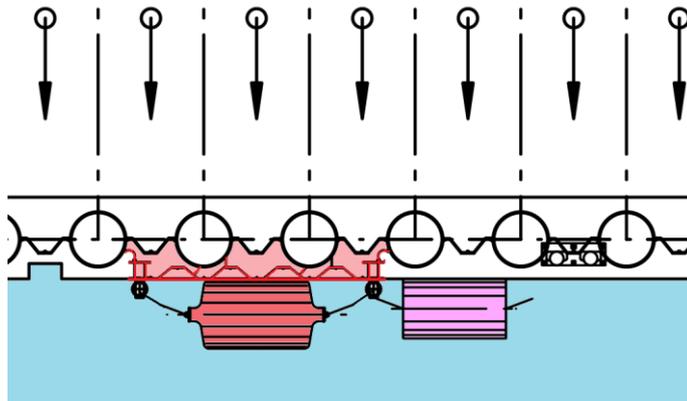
Schwimmfender mit Fenderplatte und Zylinderfender, Grundriss (Plan SE15057-GP-303_Grundriss_Rammplan)
